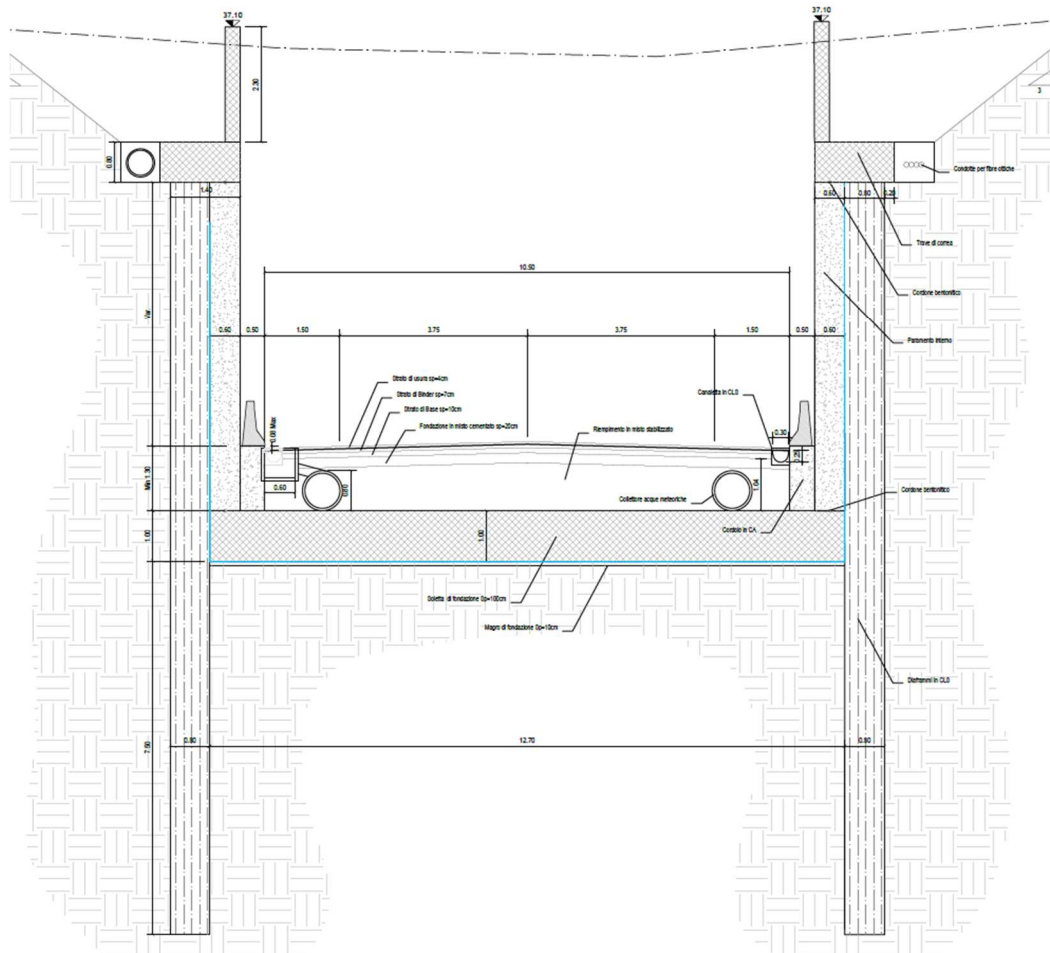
Scavo con diaframmi – sezione TIPO 3
